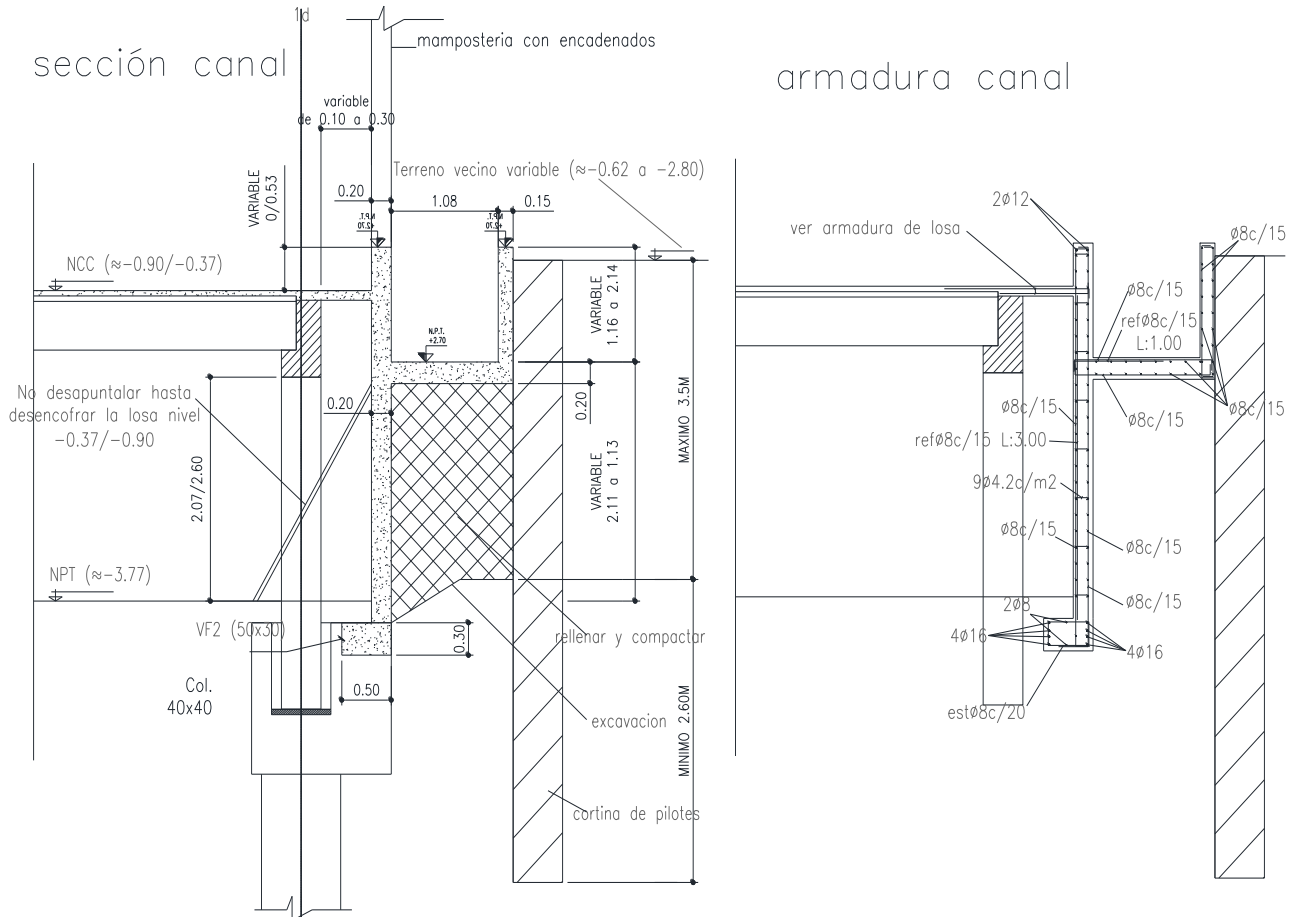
Detalle estructurales del desagüe pluvial.
